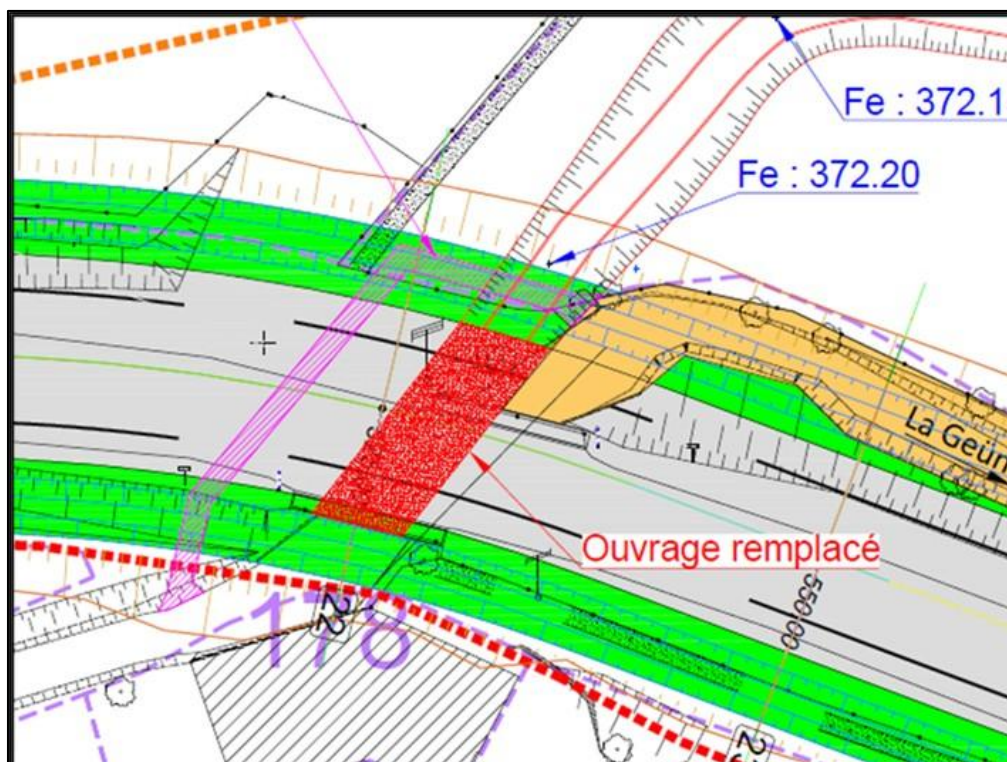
Vue en plan du nouveau dalot sur la Geüne
